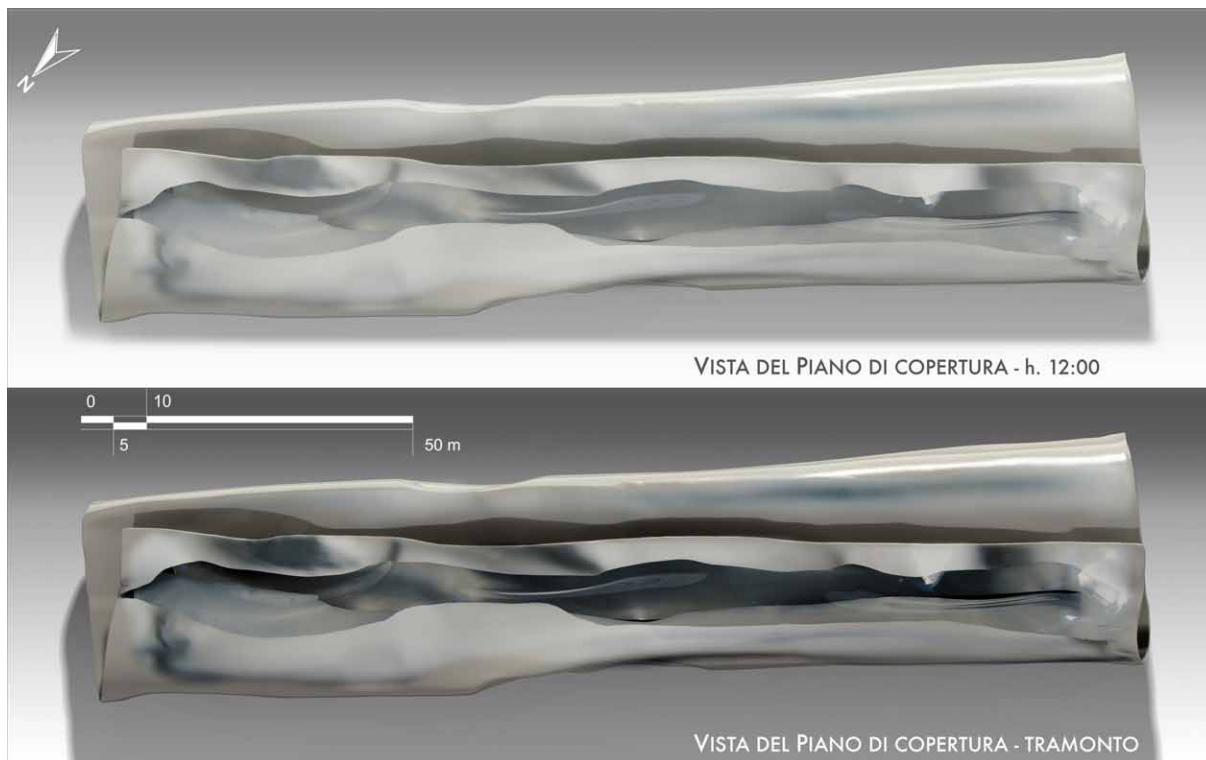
Viste render planimetriche al 21 di marzo tratte da uno studio solare sul modello
